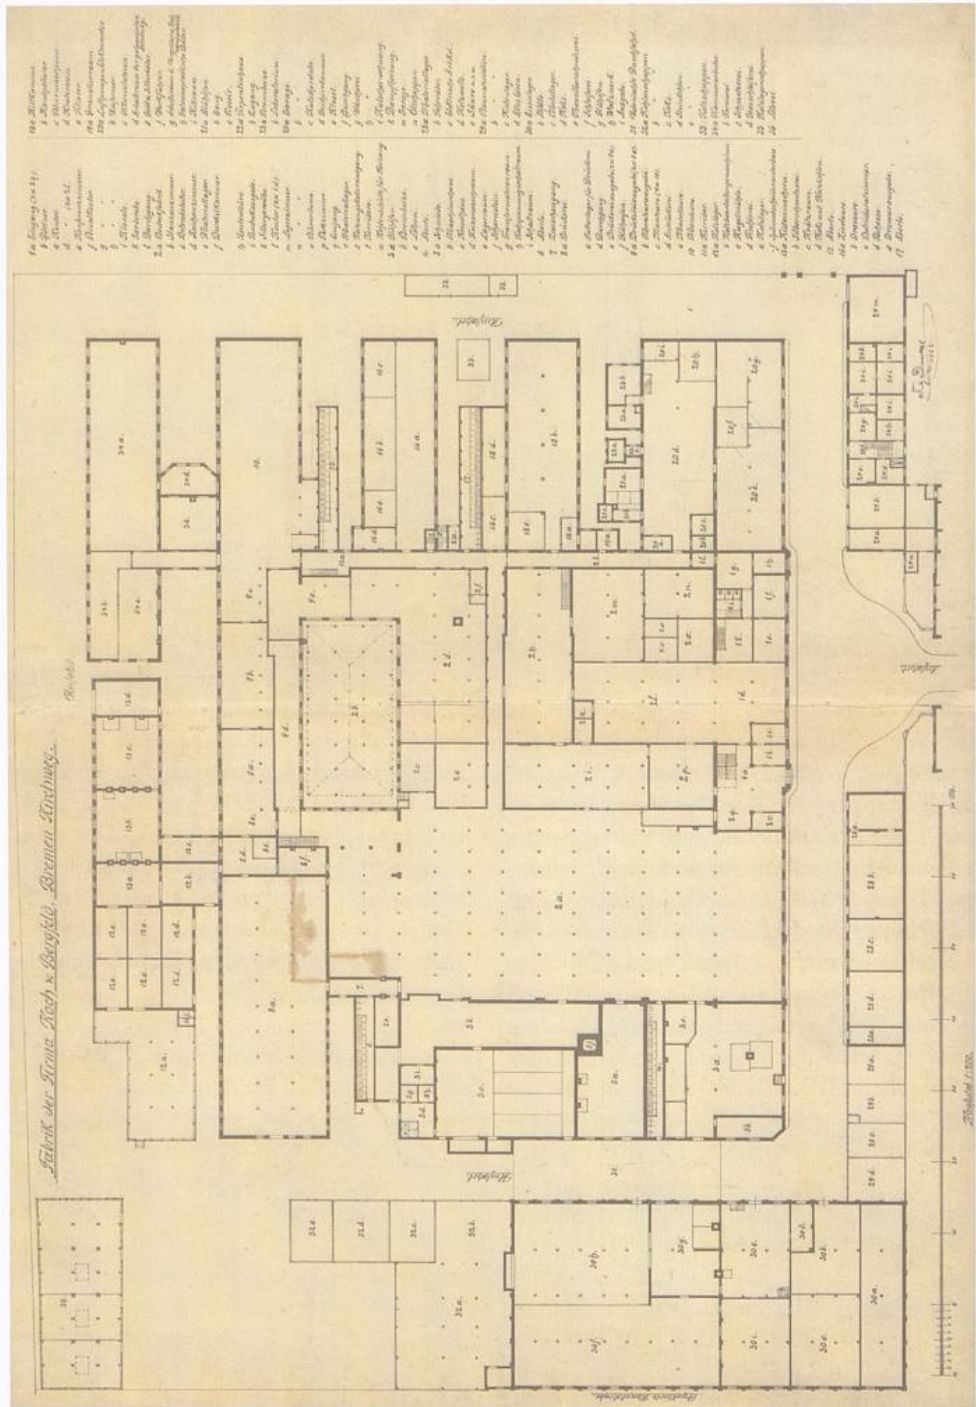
Grundriss der Silberwarenfabrik Koch & Bergfeld, Zeichnung Fritz Dunkel 1922
